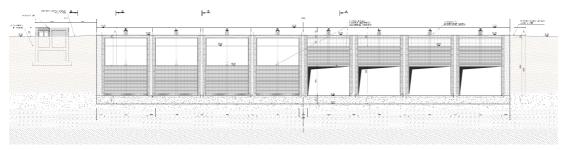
Sfioratore laterale – Sezione longitudinale dell'opera
